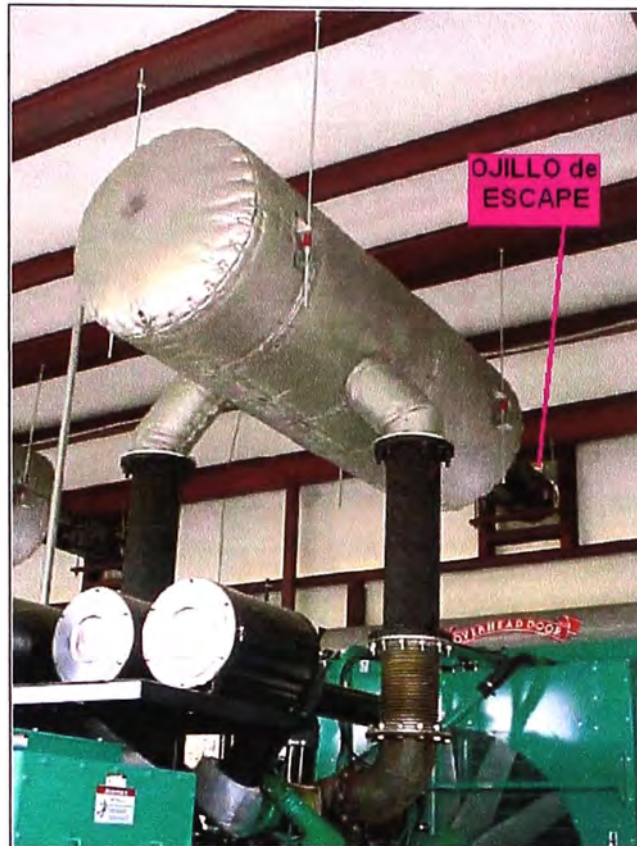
Silenciador de doble entrada con conectores flexibles y montajes colgantes
